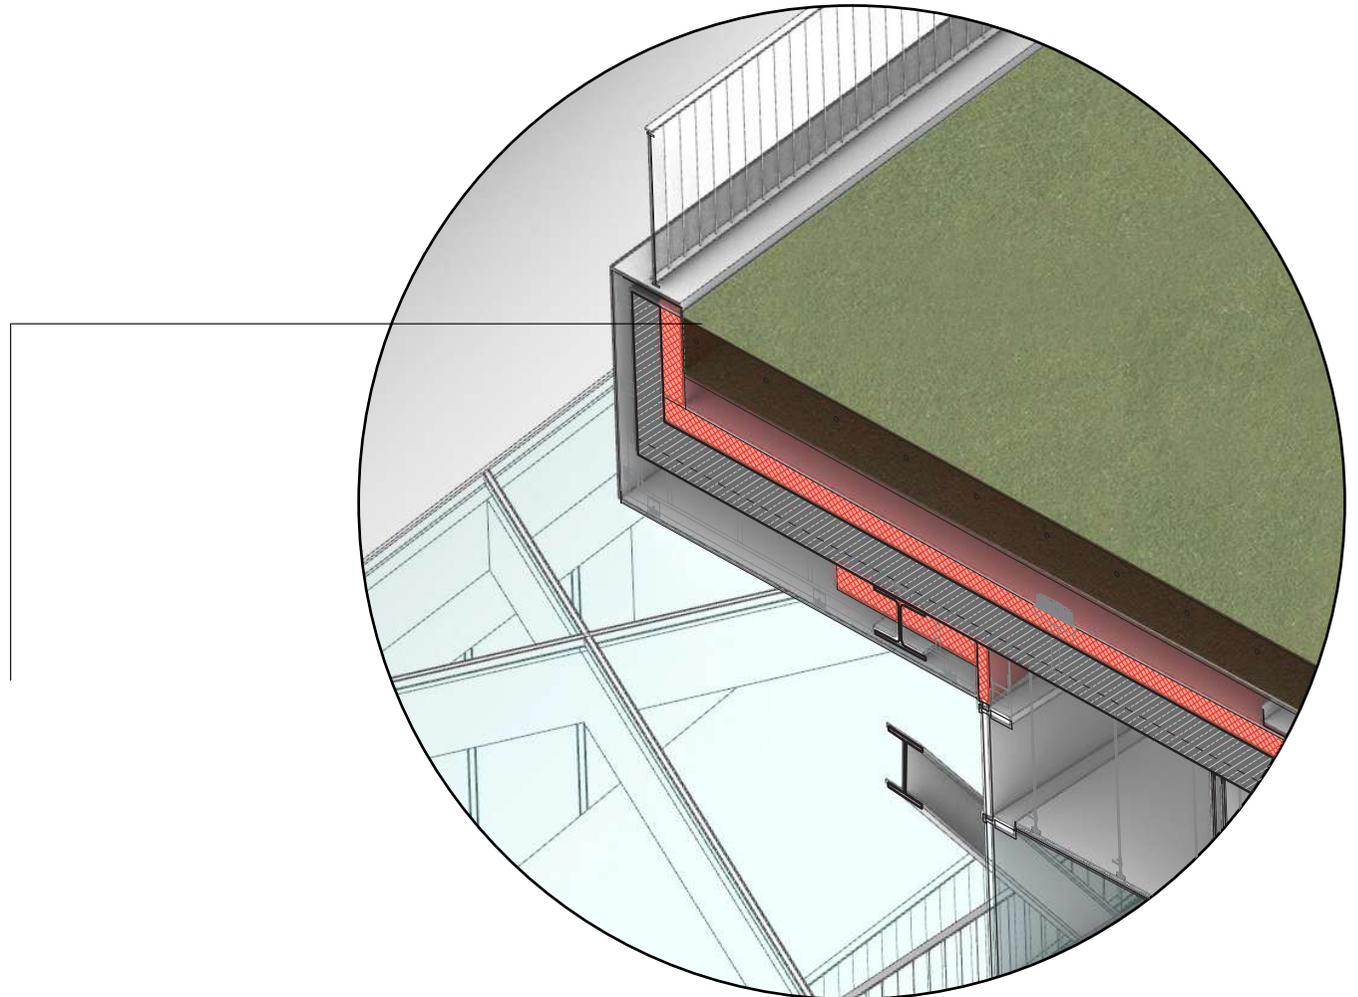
Dachaufbau, Dachbegrünung intensiv
